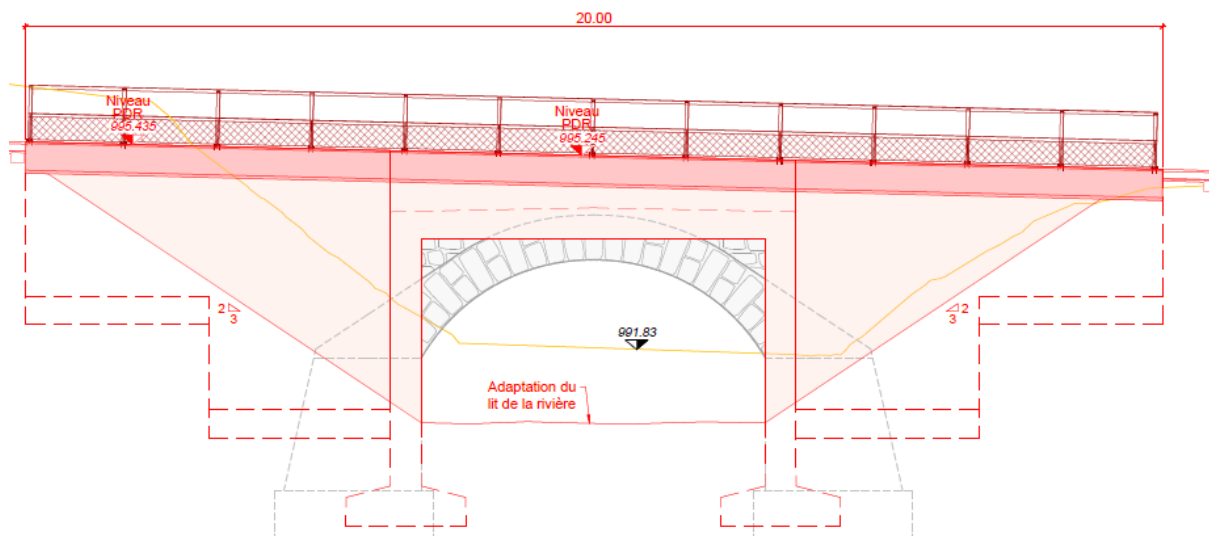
Elévation amont du pont de la Combabelle- extrait de plan
